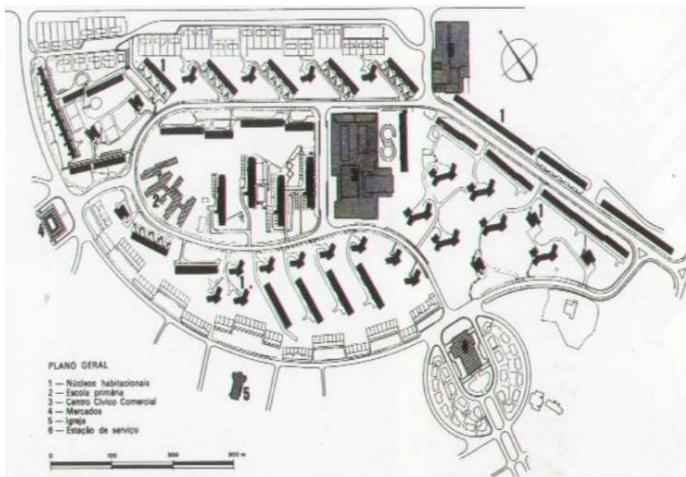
Olivais Norte – Planta do Plano e Blocos Habitacionais
